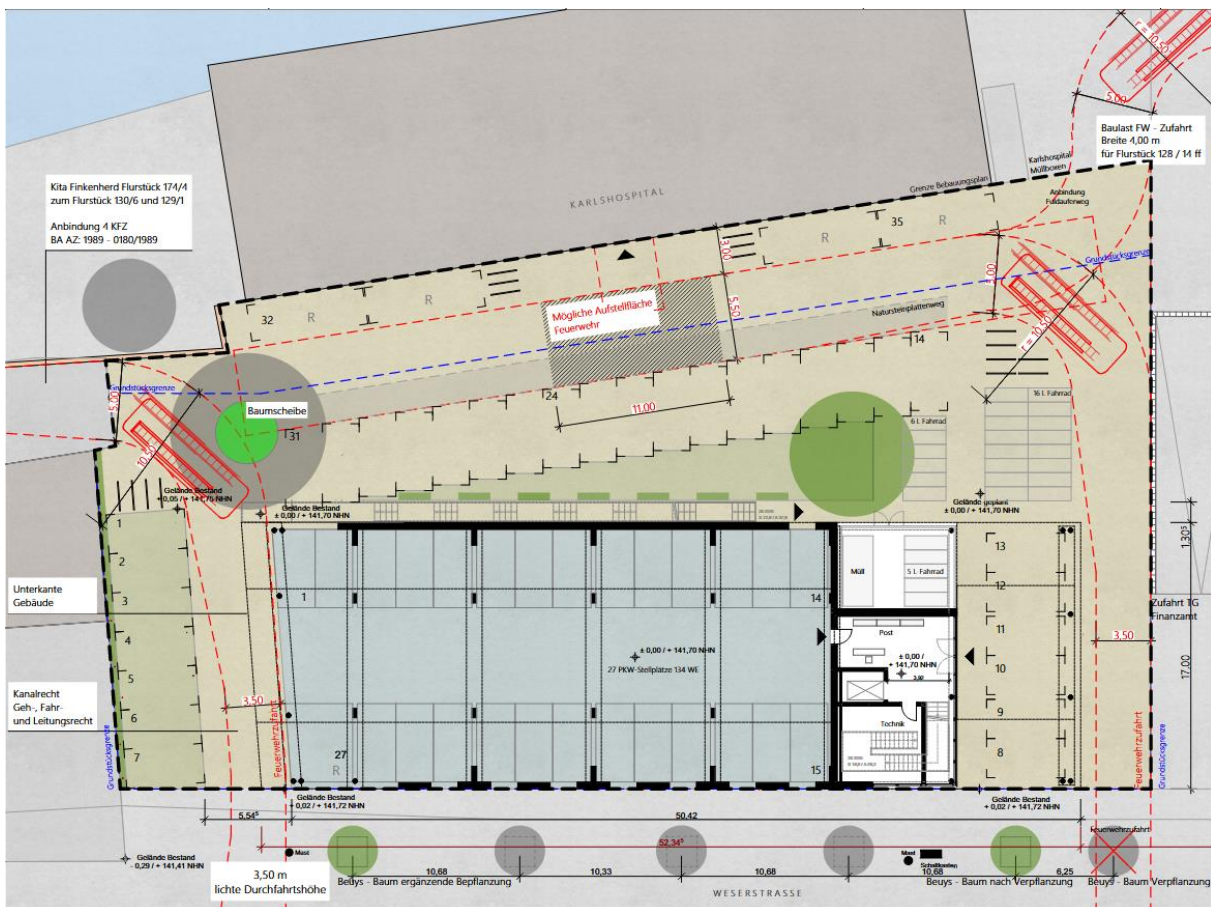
Erdgeschossplan mit Erschließung, Verkehrsflächen und Parkmöglichkeiten
